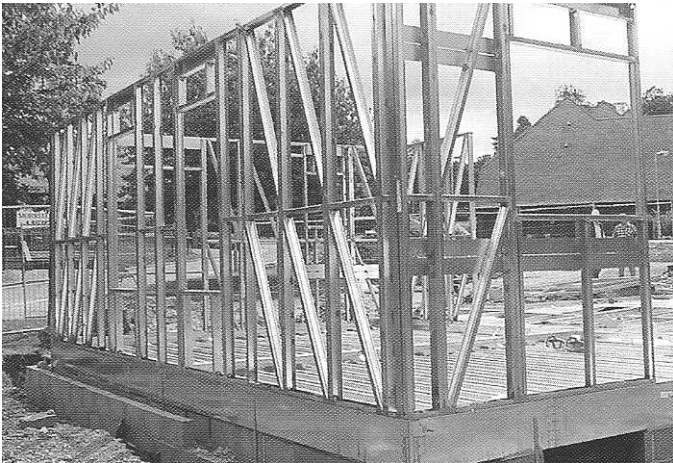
Arriostramiento en "K" (Fuente: SCI)
